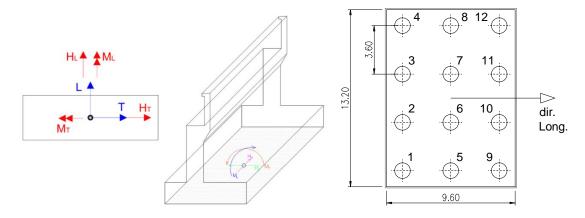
V02 – SPALLE SP1 e SP2 – pianta plinto e convenzione dei segni delle azioni agenti.
